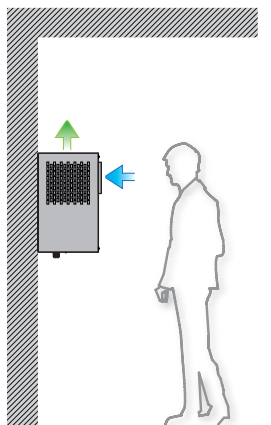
Fig. B: Sollevare il dispositivo e fissarlo a parete con l'ausilio delle asole presenti sulla piastra posteriore. Procedere infine al rimontaggio del pannello anteriore fissandolo con le apposite viti di bloccaggio.
